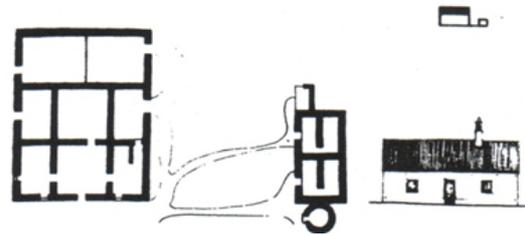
"Habitação no Algarve Central: Cobertura mista – telhado e açoteia utilizável; alvenaria de calcário, tijolo ou taipa; pavimento em tijoleira e vãos guarnecidos a cantaria."
